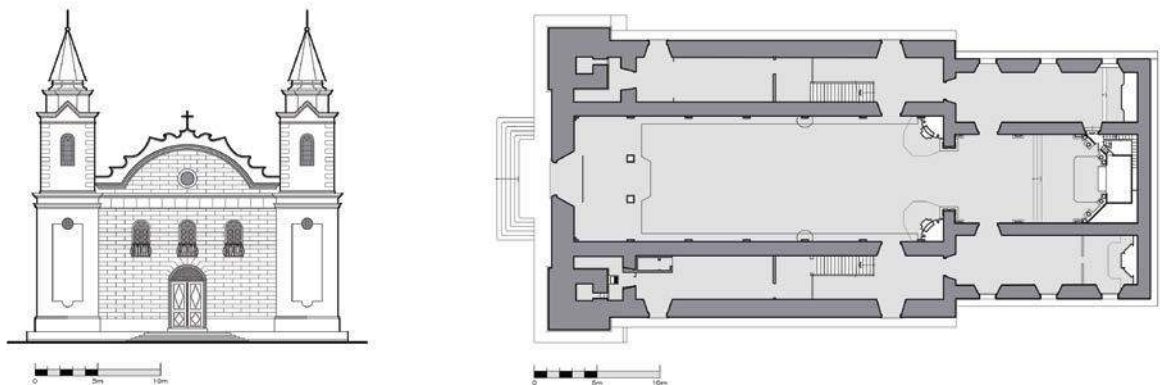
Fachada e Planta da Igreja da Boa Morte (1858-1867; o frontispício é de 1893).
